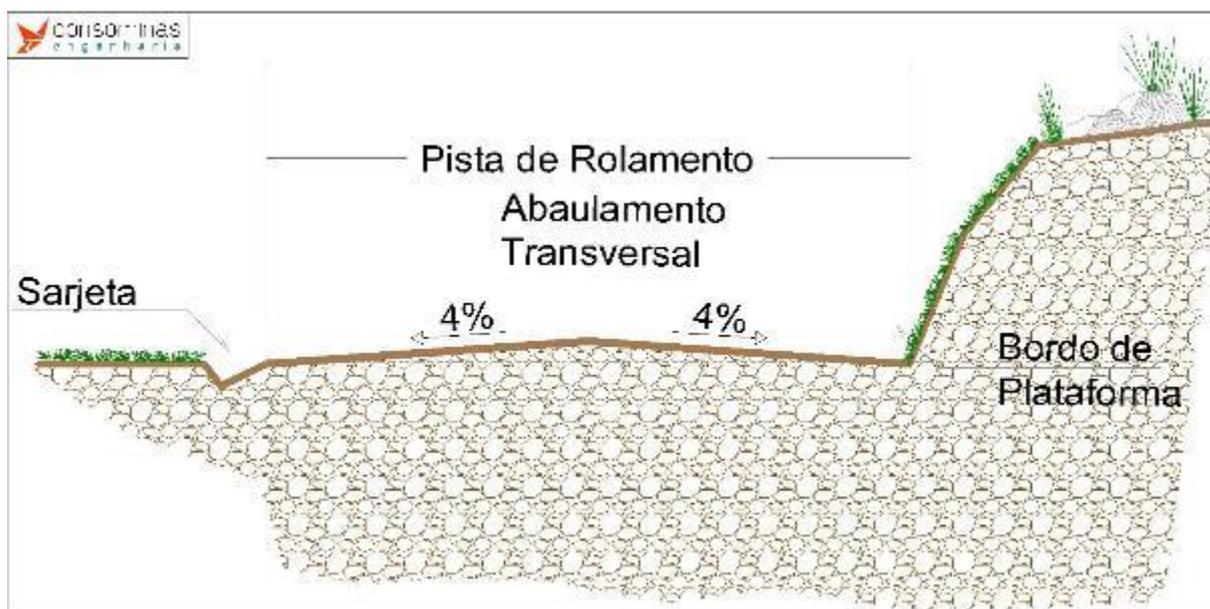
Detalhe da inclinação da seção transversal da pista de rolamento.
